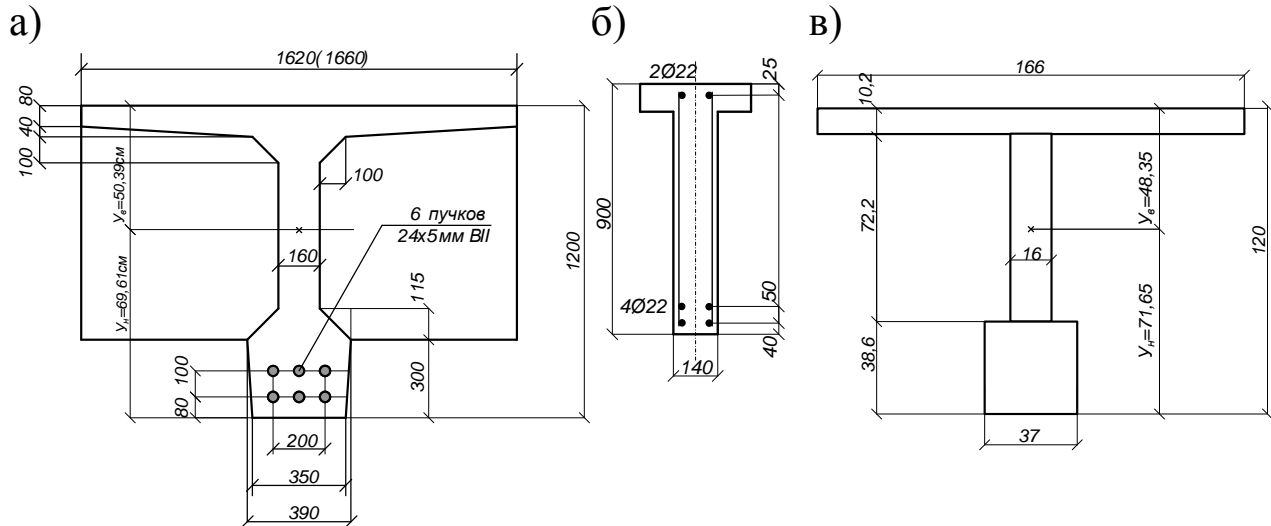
Конструкція головної балки прольотної будови по Т/П 122-63, довжиною 22,16 м: а - фактичний поперечний переріз балки; б - поперечний переріз діафрагми; в - приведений переріз балки
